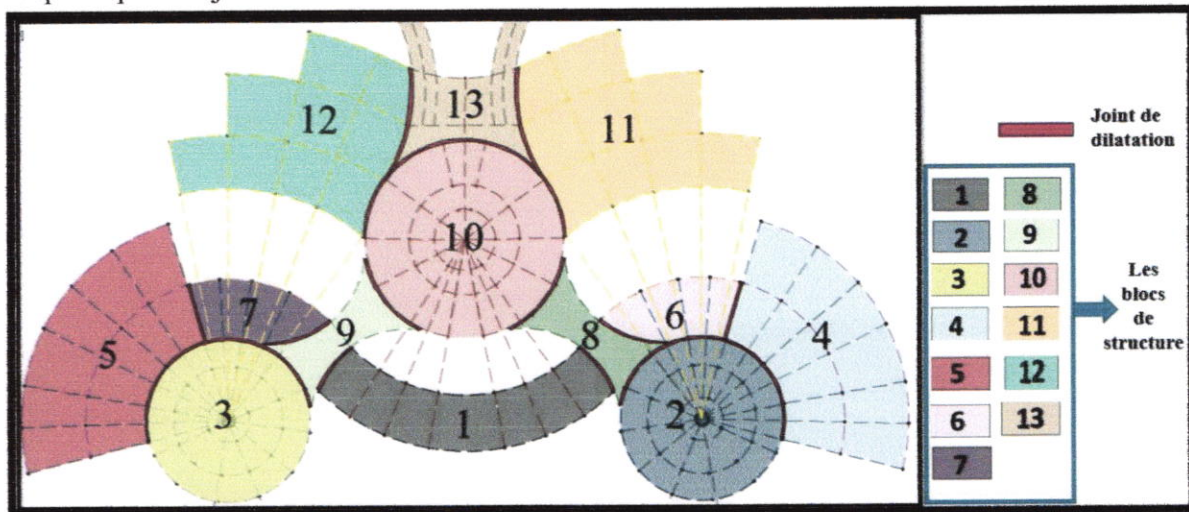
PLAN STRUCTUREL DU PROJET ARCHITECTURAL
